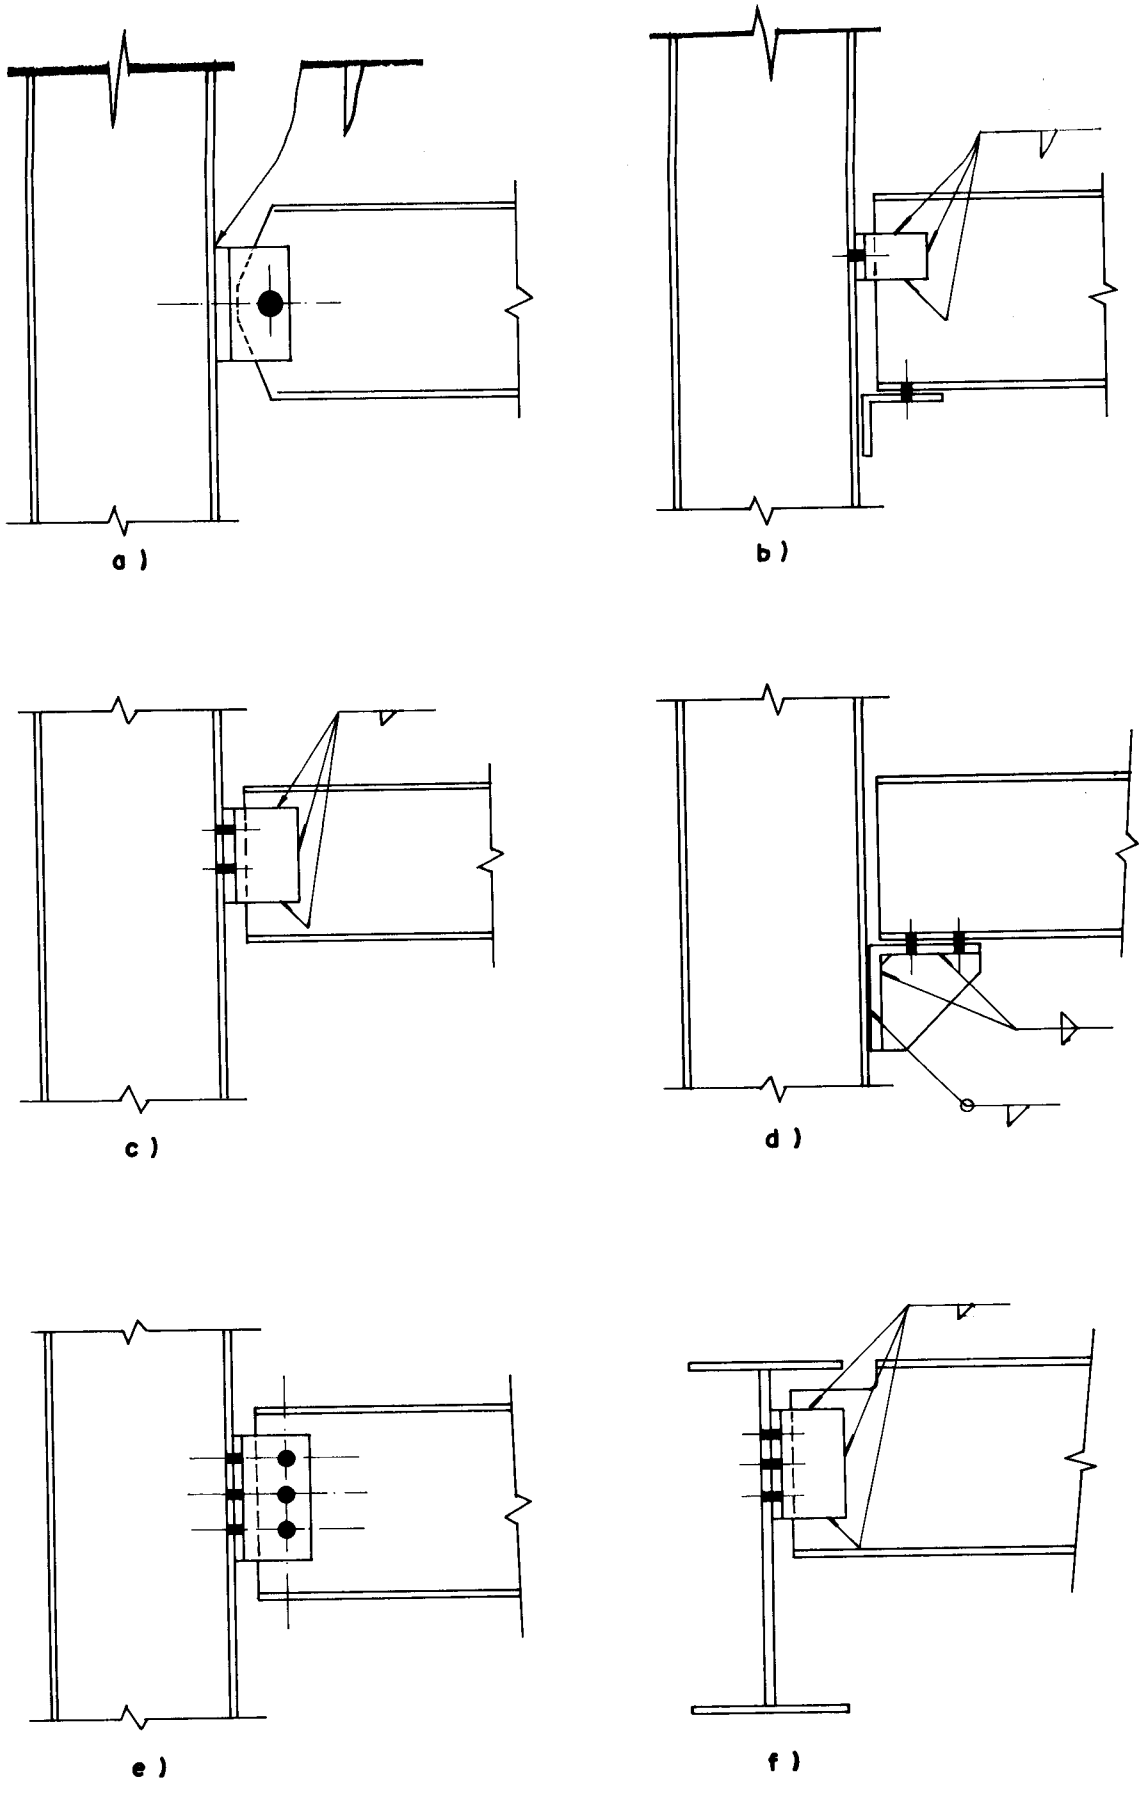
LIGAÇÕES TIPO 2 - ARTICULADAS
